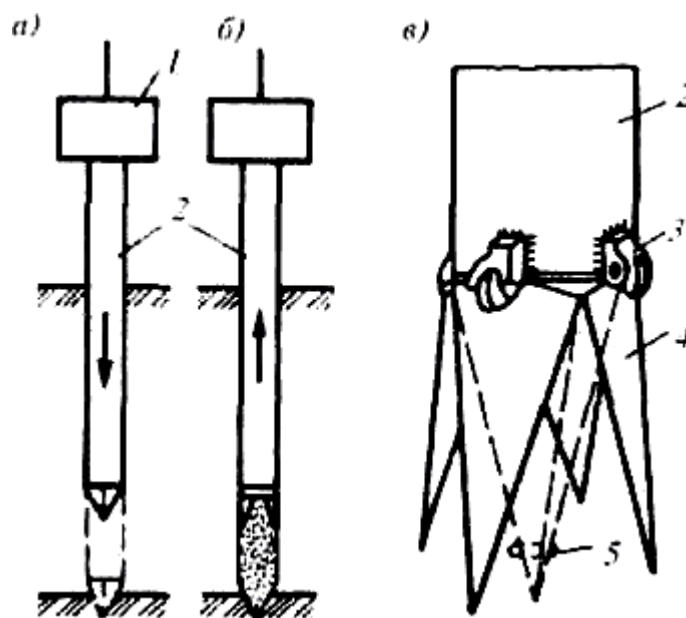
Схема устройства песчаных (грунтовых) набивных свай:
